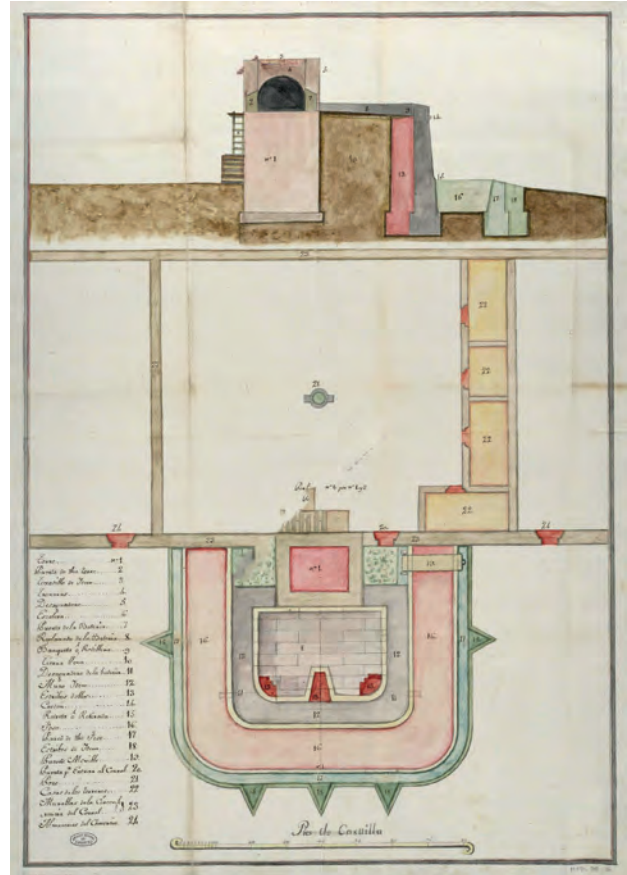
Alzado, plano y perfil de la Batería de Murviedro. Año 1780. Archivo General de Simancas.
